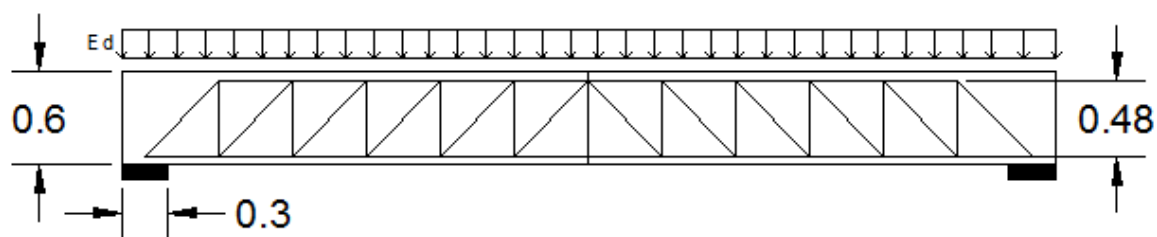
Modelo de escoras e tirantes adotado para a Viga 2.
